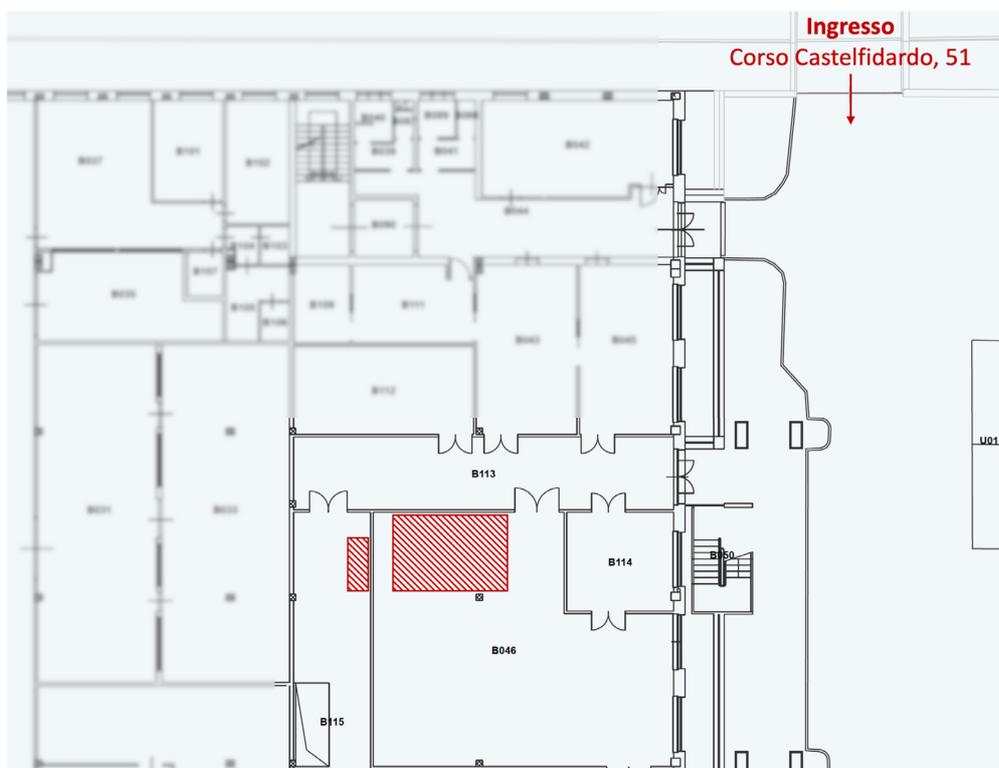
Planimetria con indicazione approssimata delle aree di installazione.
